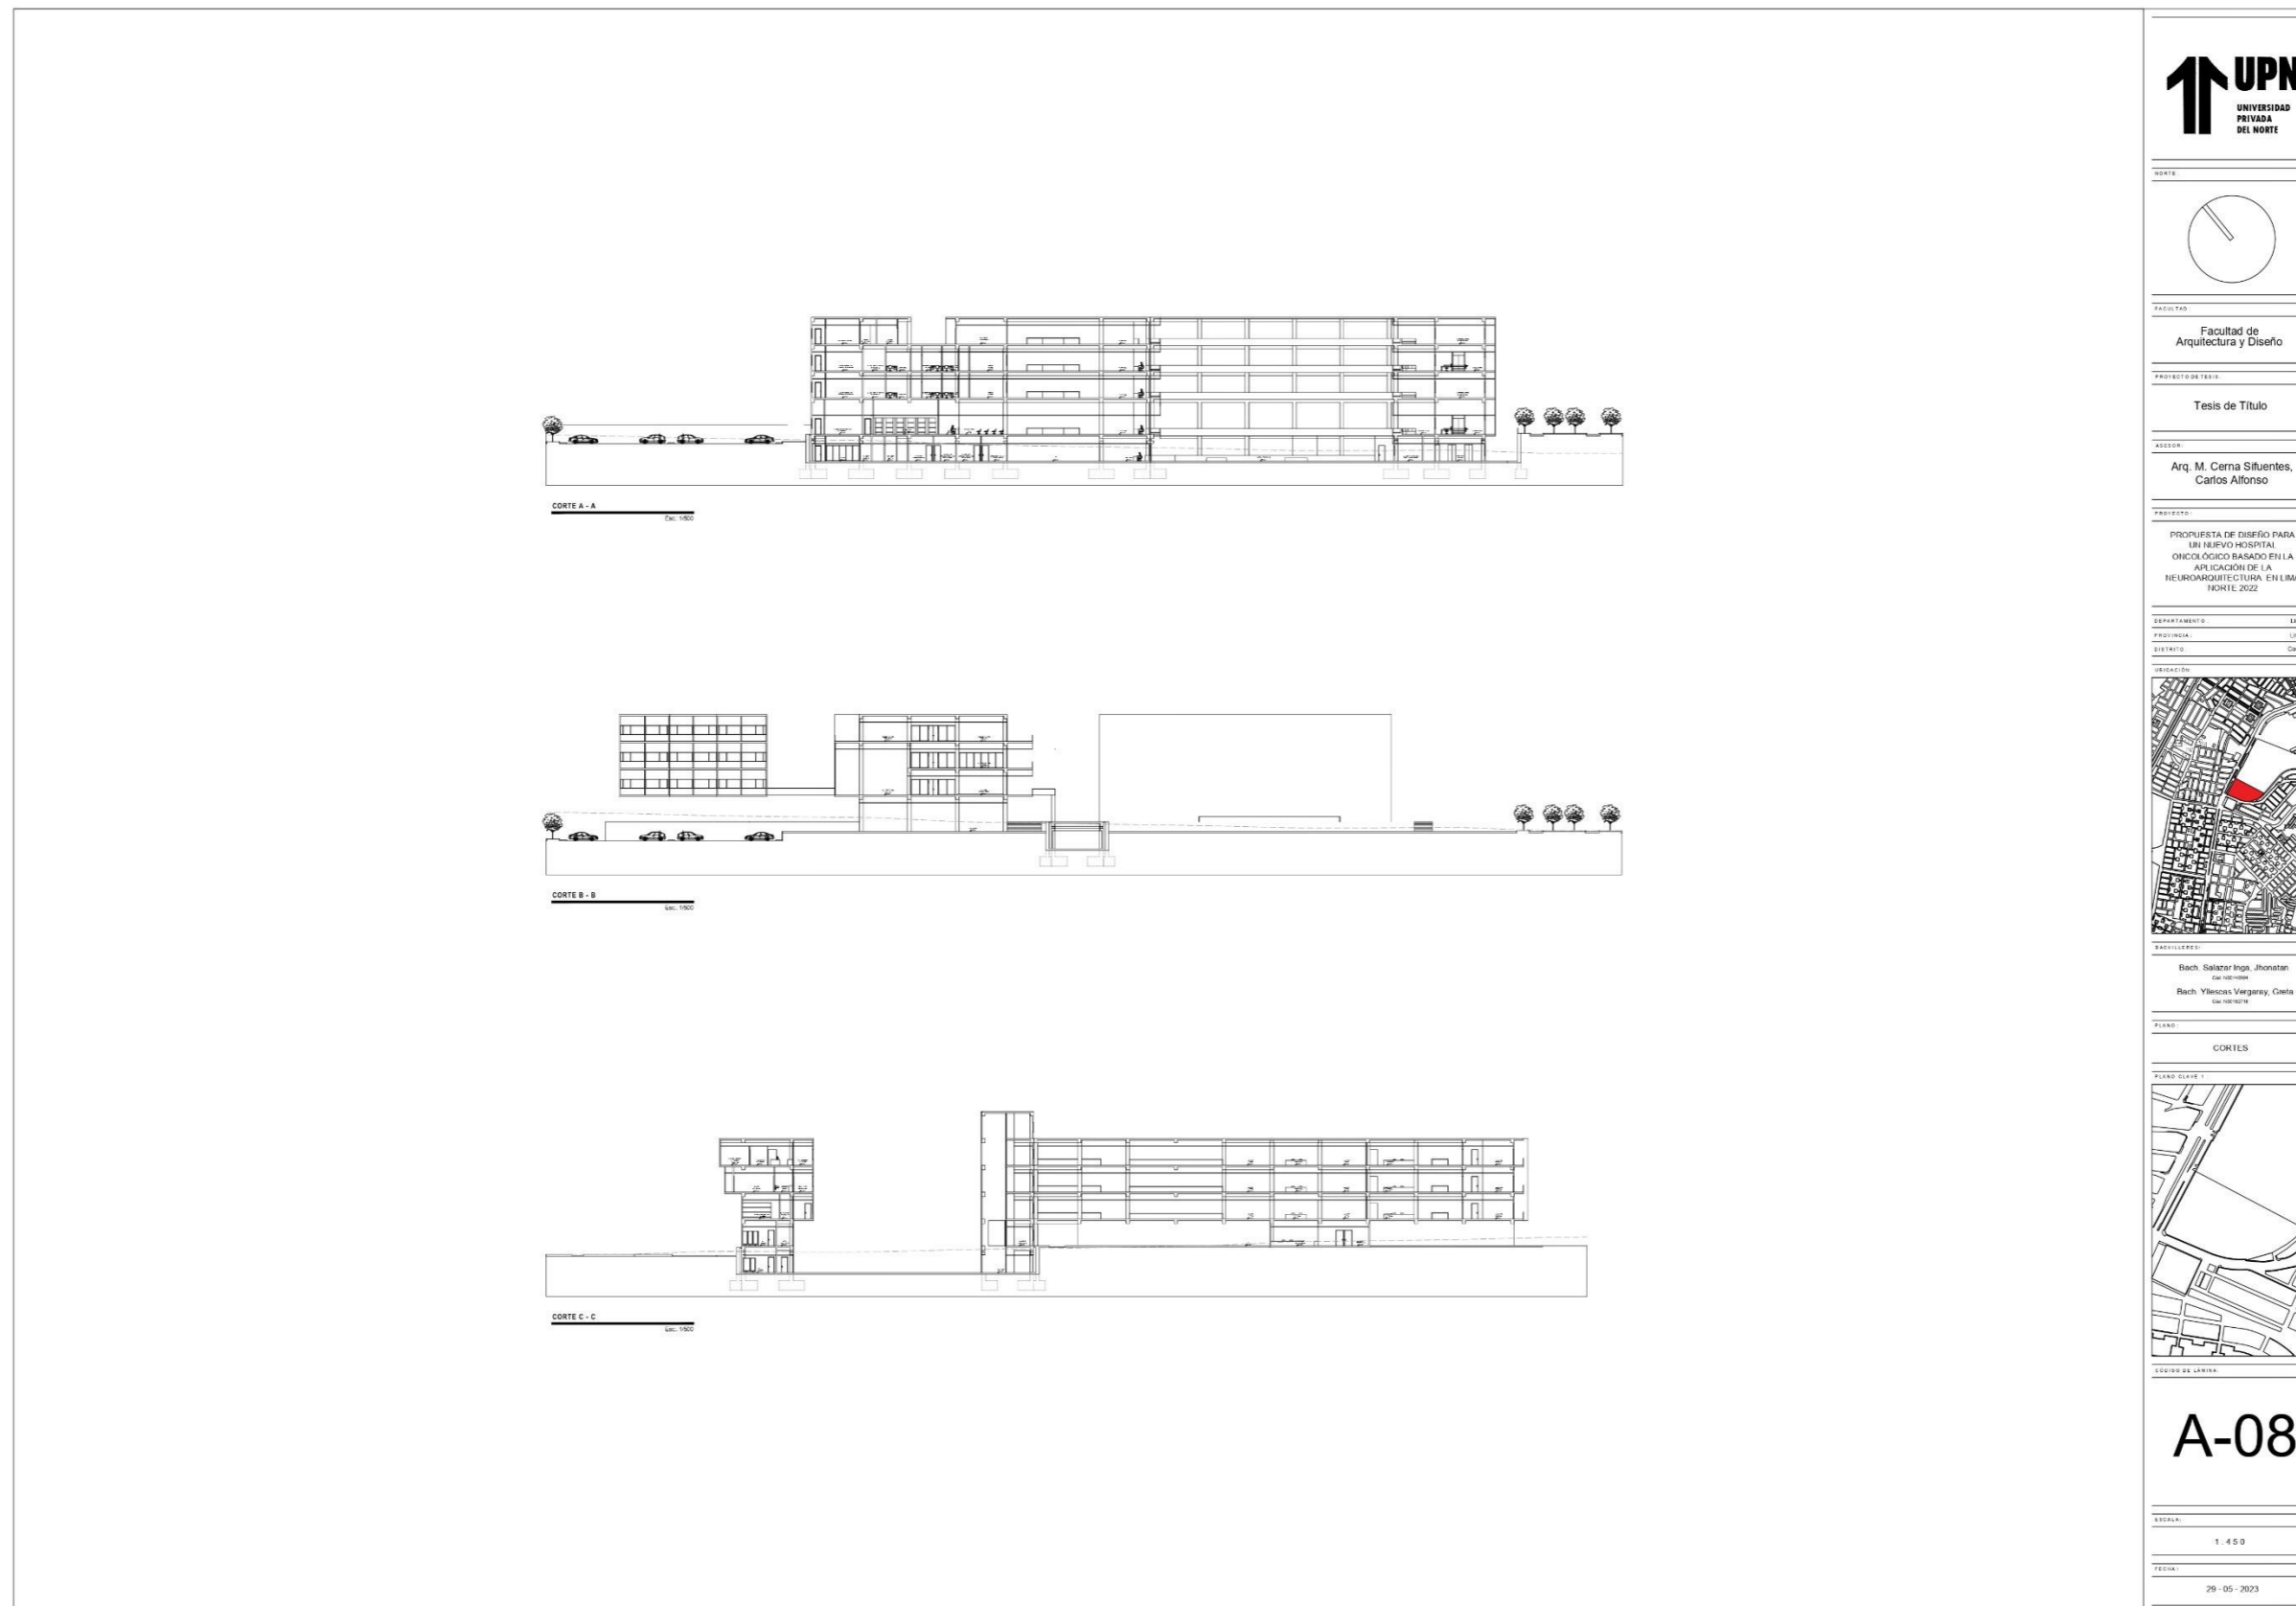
Arquitectura – Cortes N°1 Esc: 1/450 (Fuente: Elaboración propia de los coautores)
